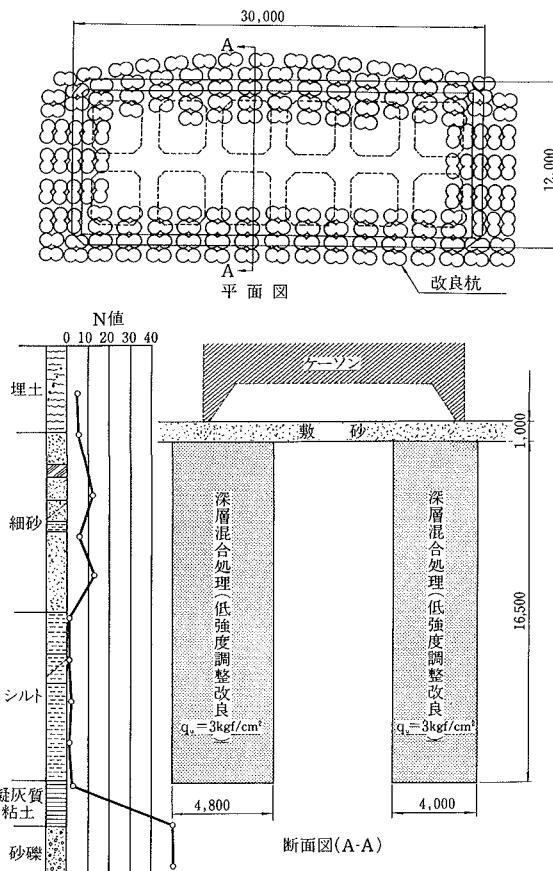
ケーソン沈設工事に伴う深層混合処理地盤改良工事の平面図と断面図
